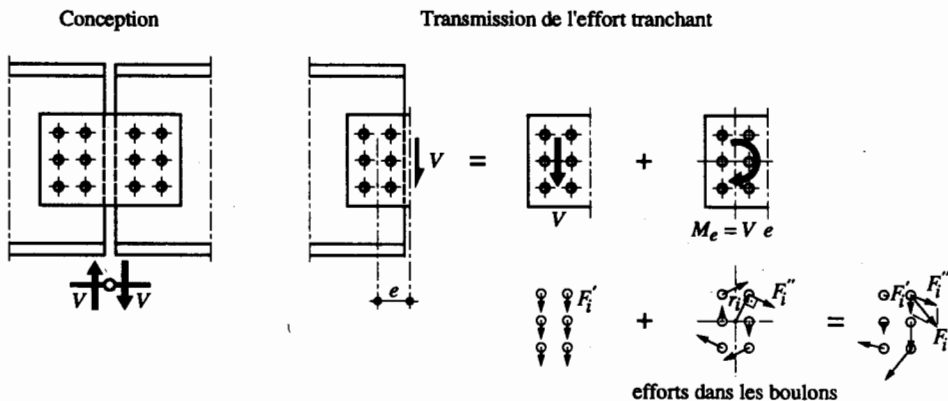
Joint de poutre par couvre-joint(s) d'âme entièrement boulonné(s).
